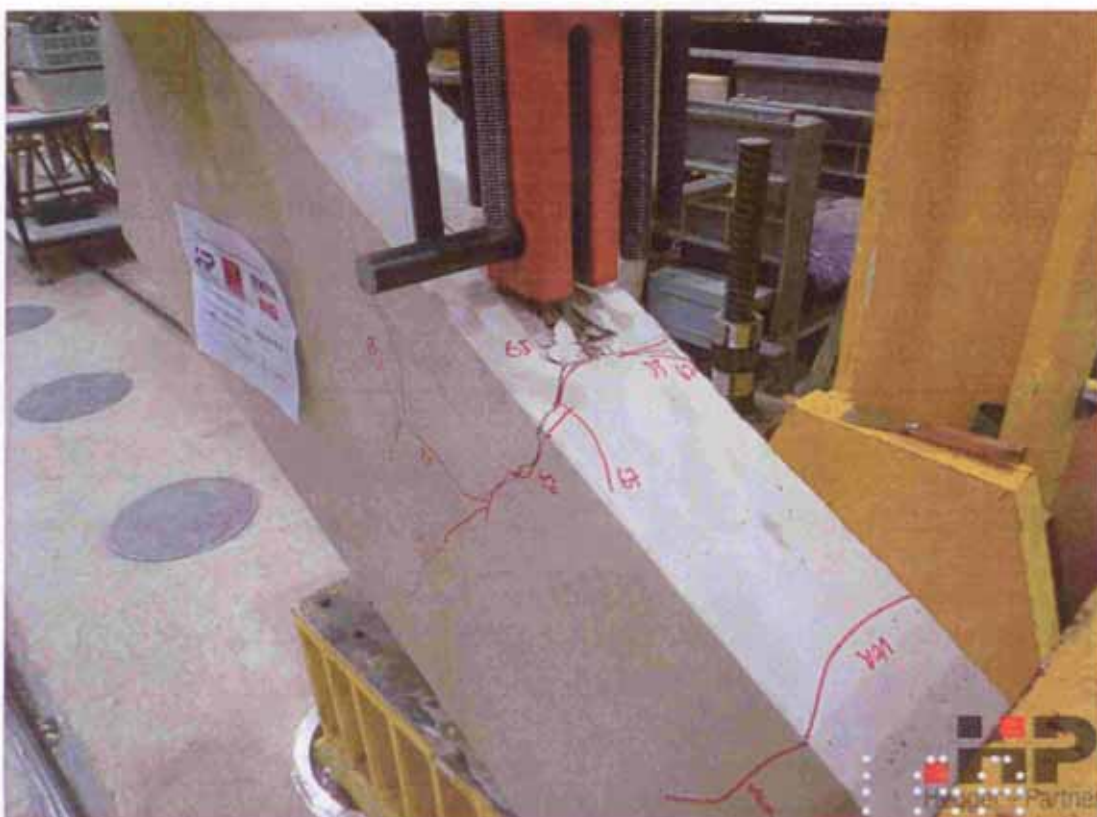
Rissbildung und lokale Betonabplatzungen im Ankerbereich
